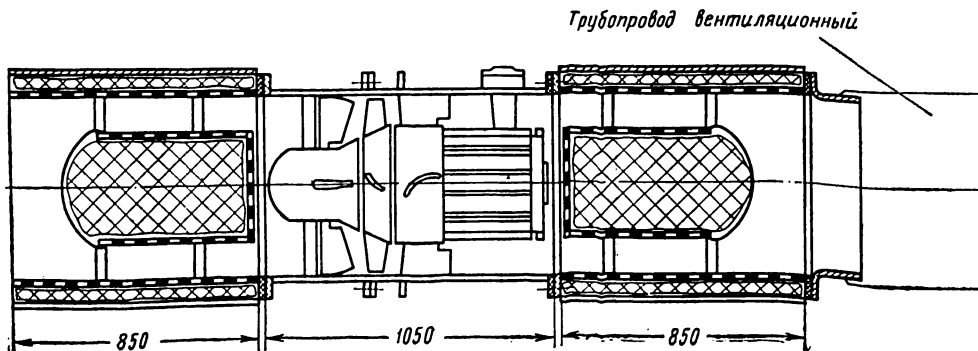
Установка вентилятора ВМ-6М с глушителями шума ГШ-6
